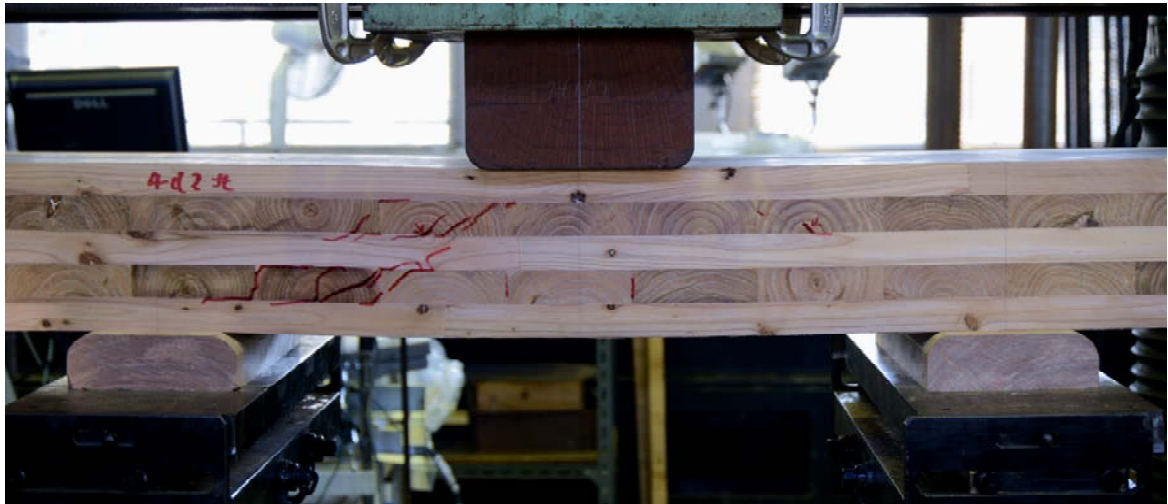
セン断ひび割れ発生時の性状(4d2)
